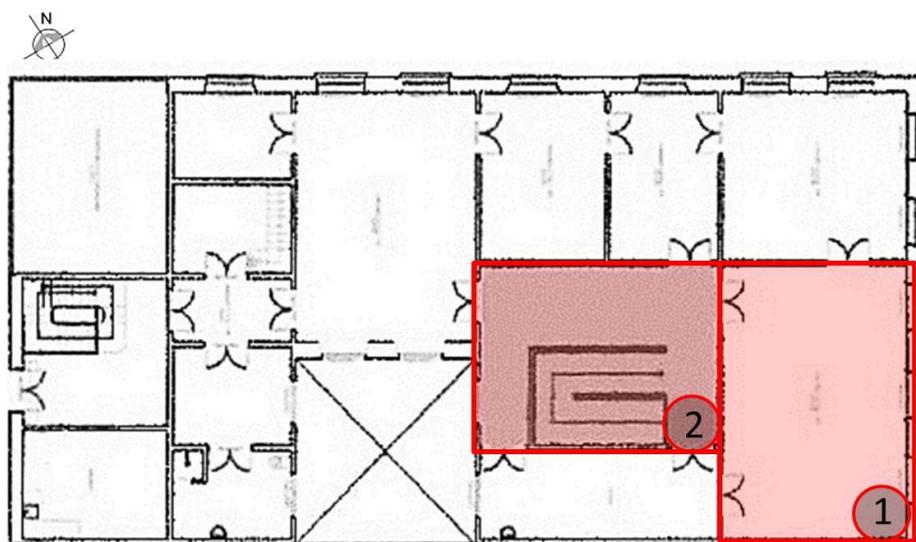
Planta baixa do pavimento superior sobrado Francisco Alsina (1876), Pelotas, RS.
